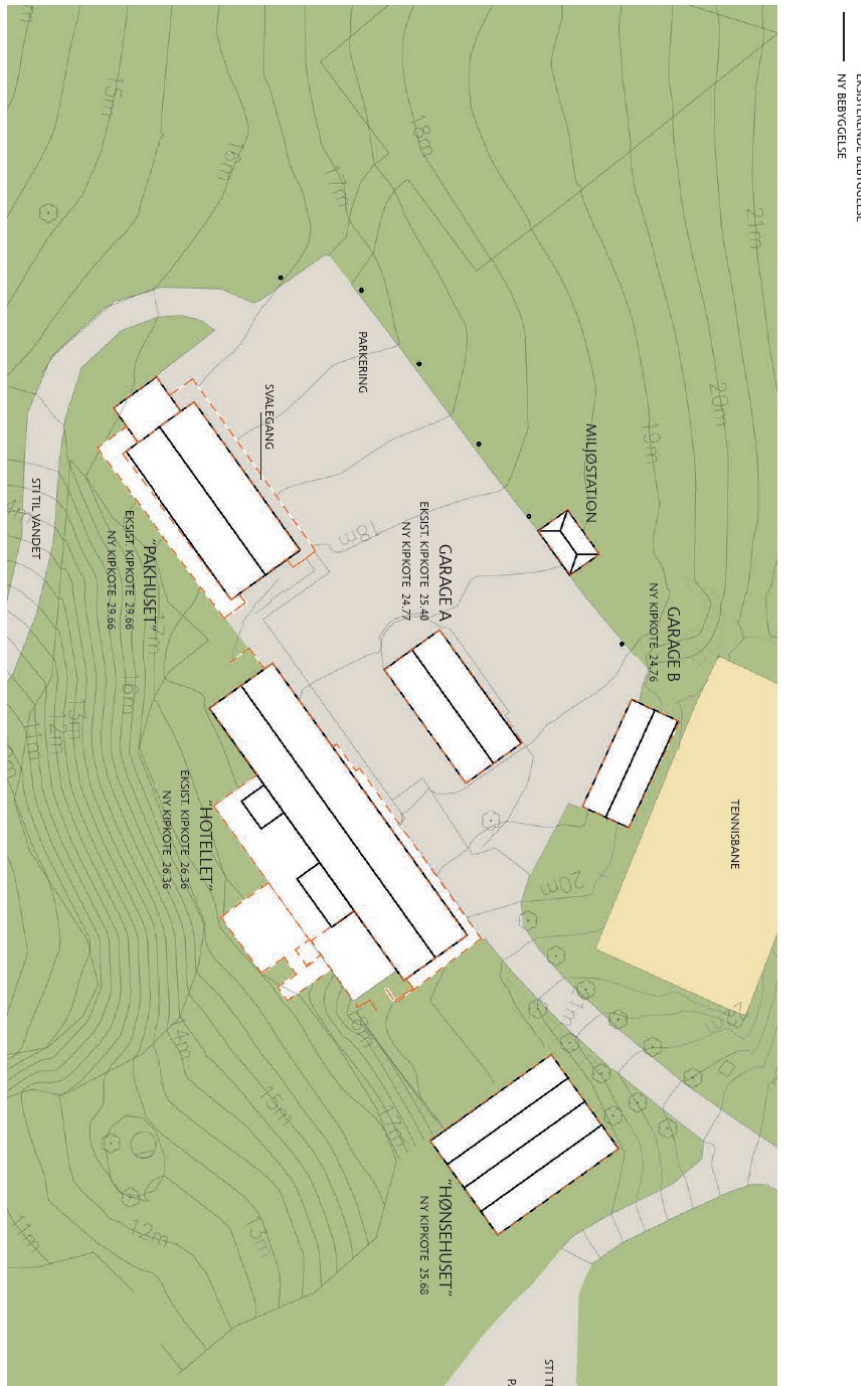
Situationsplan fra ansøgningsmaterialet. Viser placering af den eksisterende bebyggelse og den ansøgte bebyggelse.
